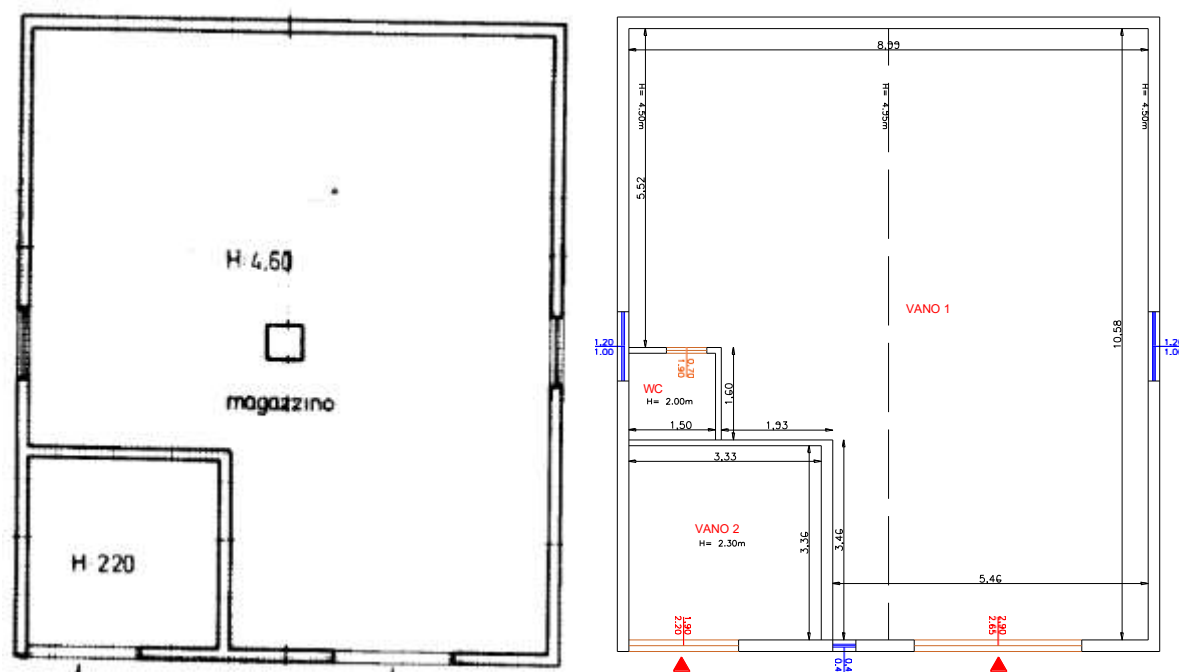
Raffronto planimetrie catastali (sopra) e planimetrie da rilievo (sotto) – PART 367-368 – SUB 1101 – BENE M
